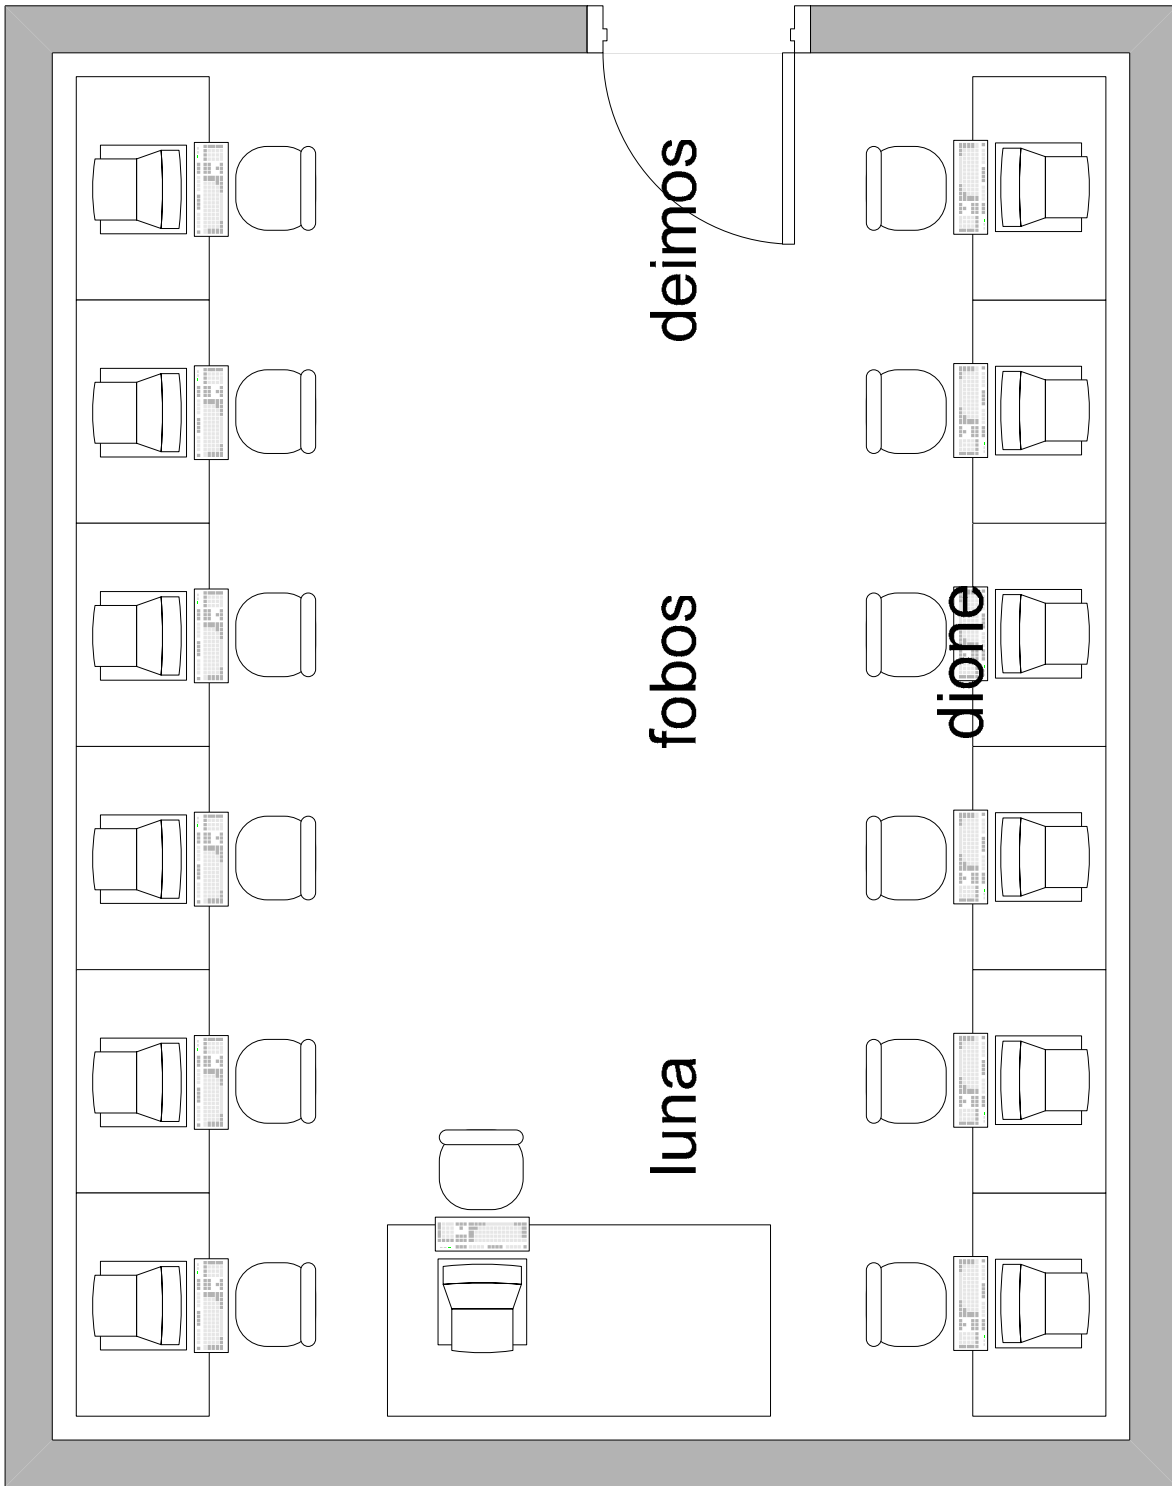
Distribución en Planta de la Sala de Tesistas
